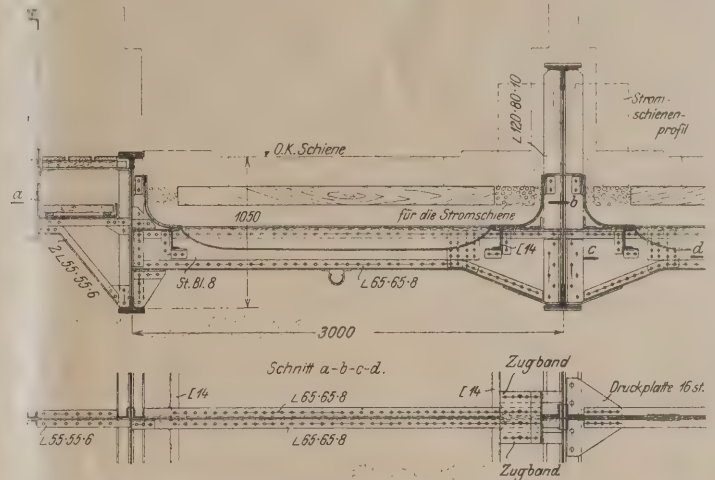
u. 11. Normal-Schnitte durch die Fahrbahn. Querträgerverbindung durch den mittleren Hauptträger.
